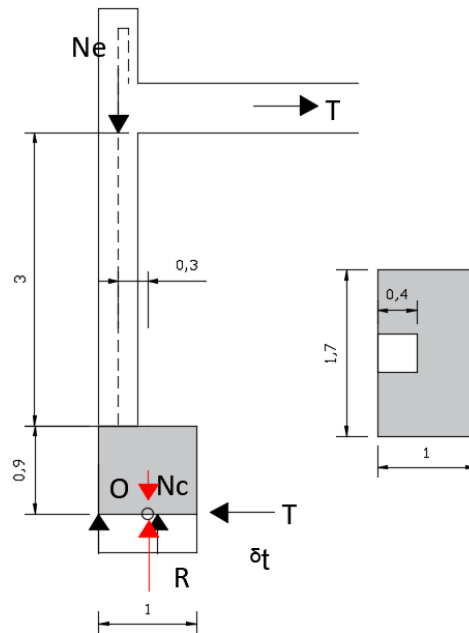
Zapata de medianería mediante la reacción del primer forjado.
